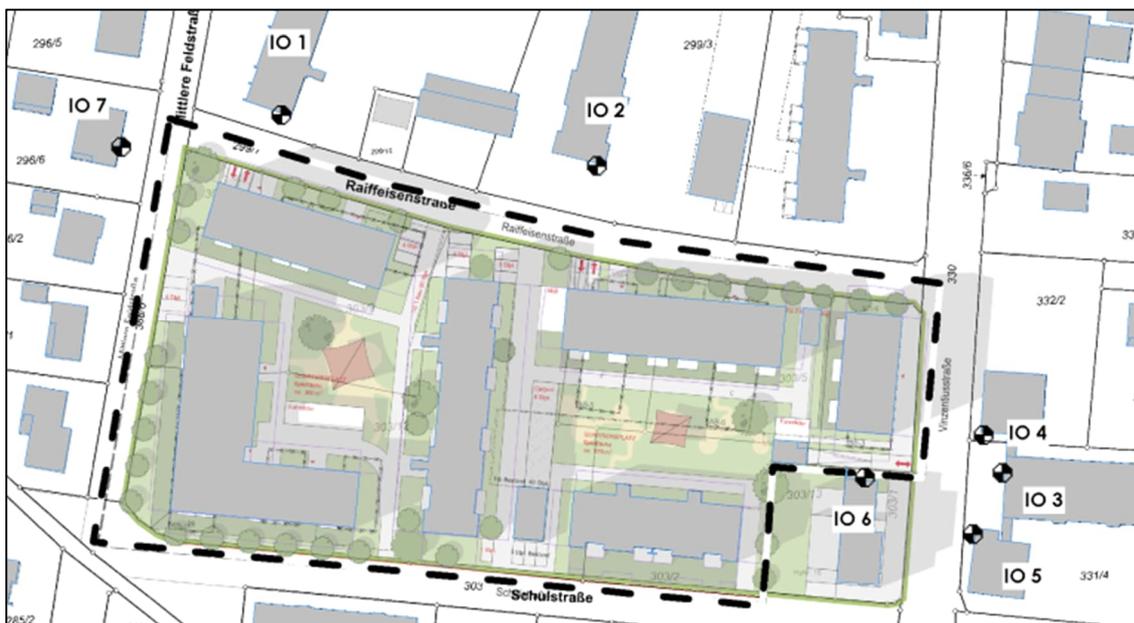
Lageplan /20/ mit Darstellung der maßgeblichen Immissionsorte IO
